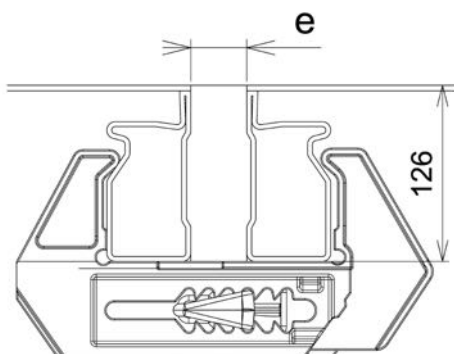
Coupe sur assemblage avec serrure PERFORM – Art 820000
